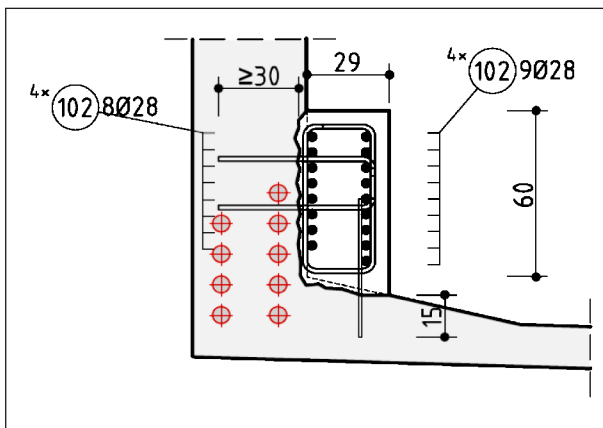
Verstärkung durch zusätzlich angeordnete Bewehrung in nachträglich anbetonierten Querschnittsergänzungen
